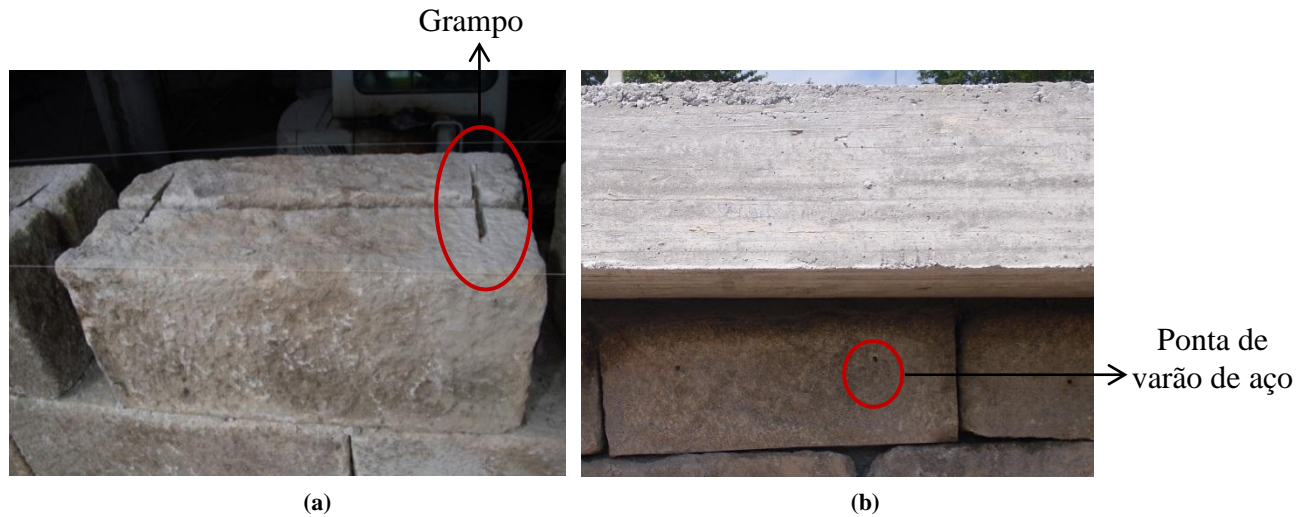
Colocação de grampos (a) e fixação das pedras às vigas através de pontas de aço (b)
